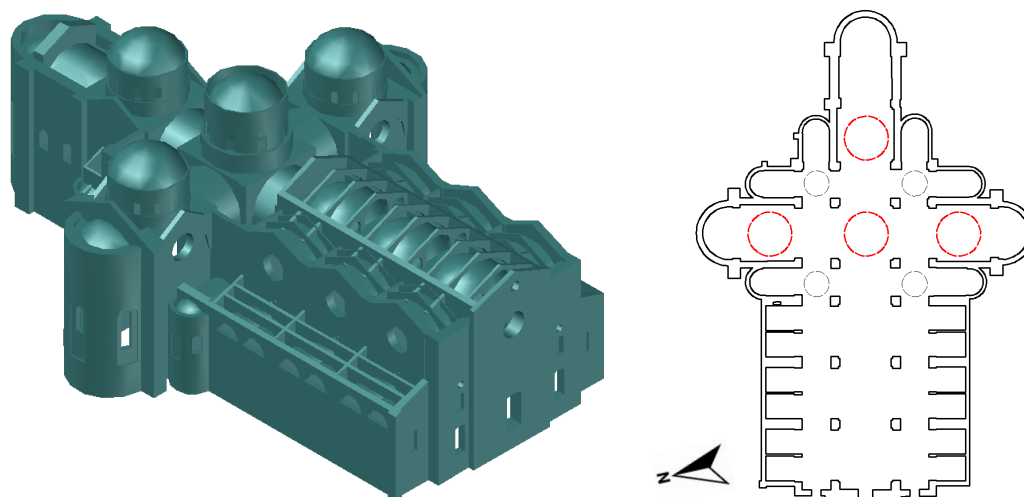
Vista assonometrica e pianta della fase 6 della struttura.
